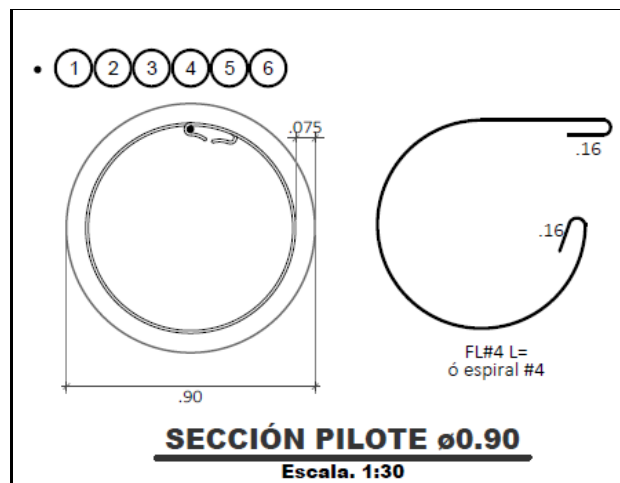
Detalle de Refuerzo Vertical Elemento Pilote 51-01.
